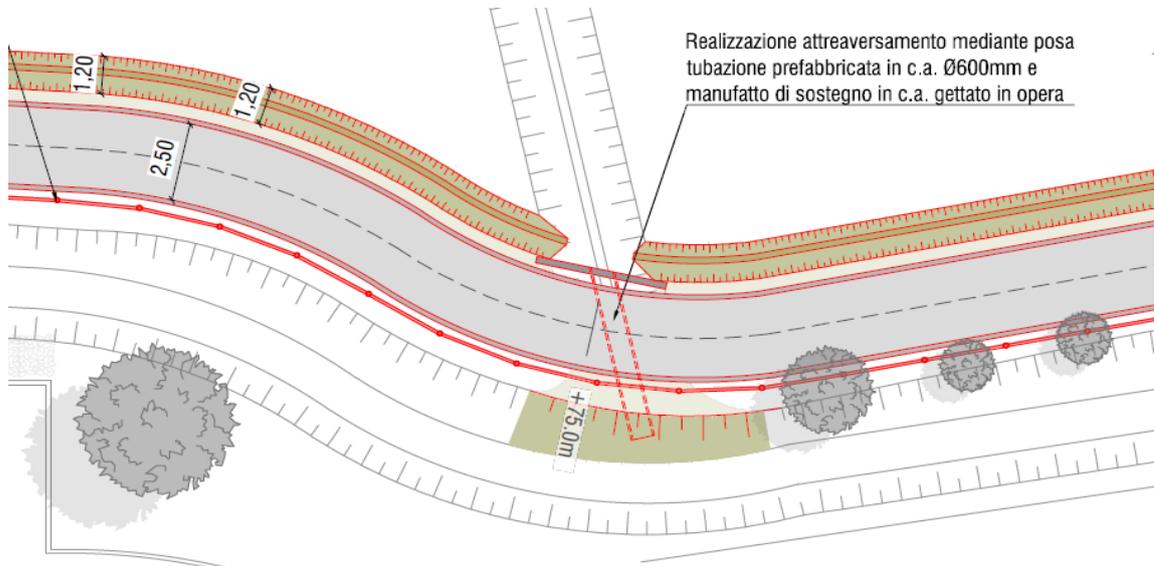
Planimetria di progetto – particolare attraversamento della Roggia Ceresina e di via Roma
